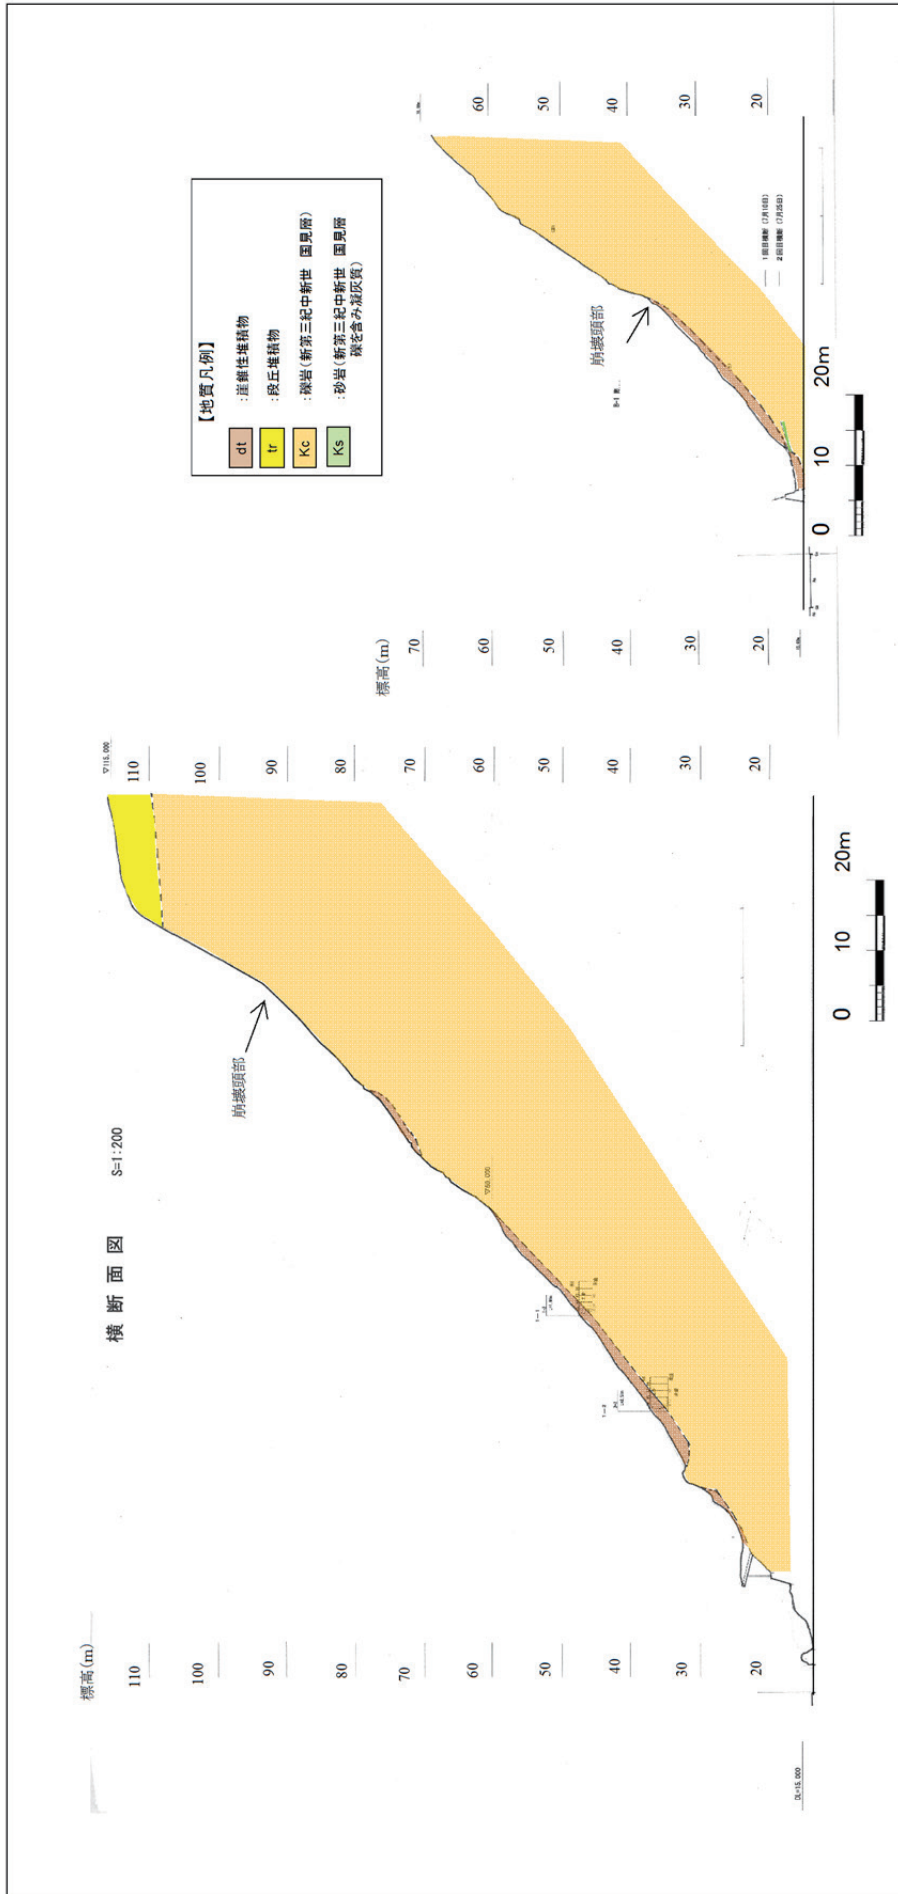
崩壊斜面 A, B の地質横断面図 (スケッチ図)
